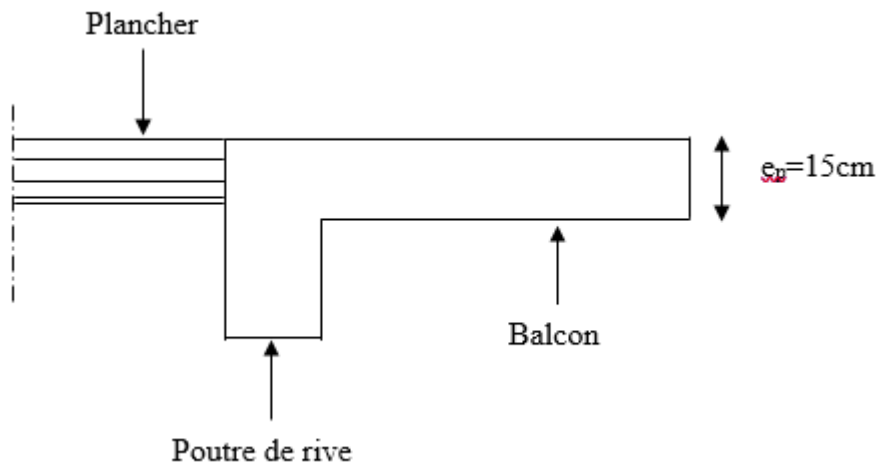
Coupe verticale détaillant la liaison balcon poutre.
